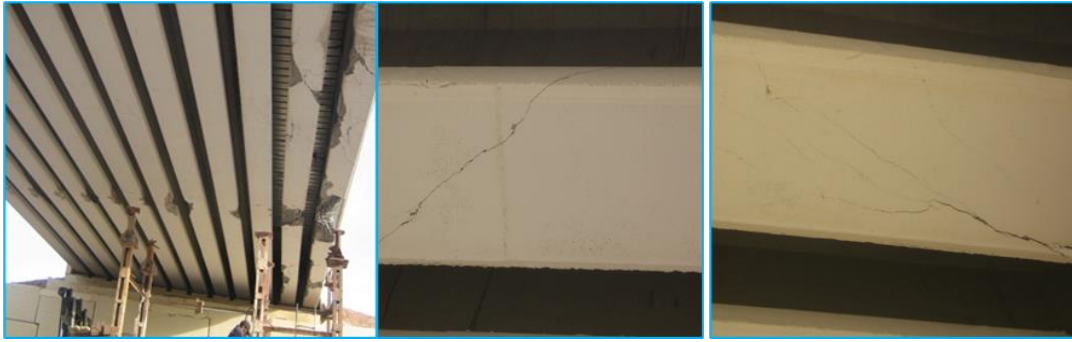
Différentes Fissures sur plusieurs poutres de l'ouvrage
